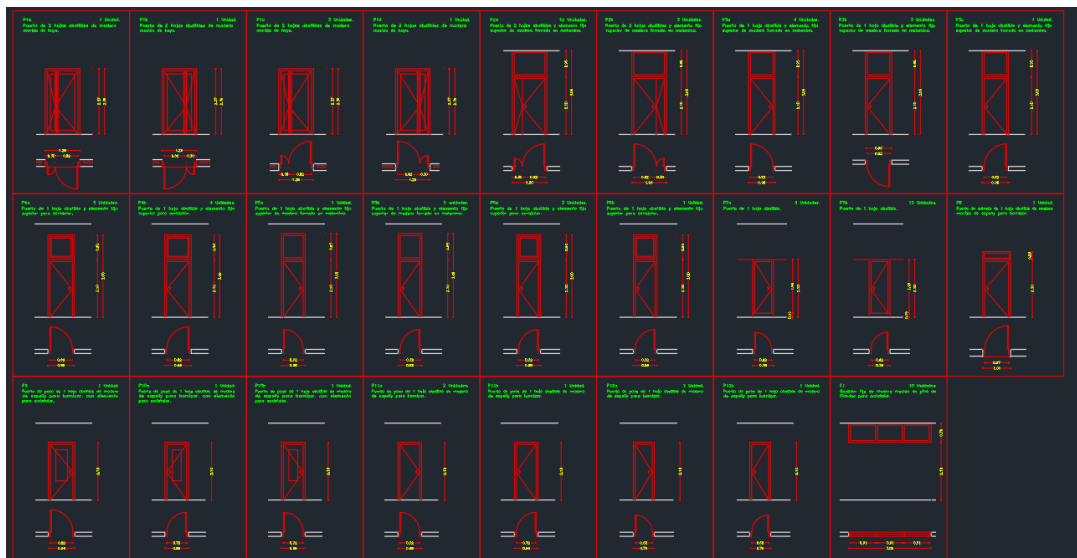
Plano de carpintería de madera del proyecto real en AutoCAD.
